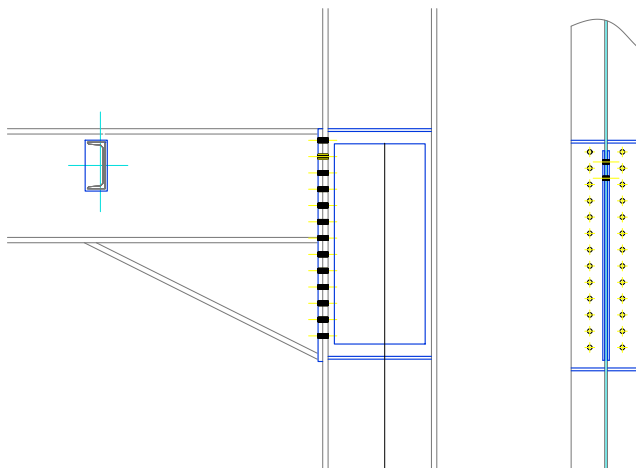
Assemblage rigide poutre-poteau des poutres principales
